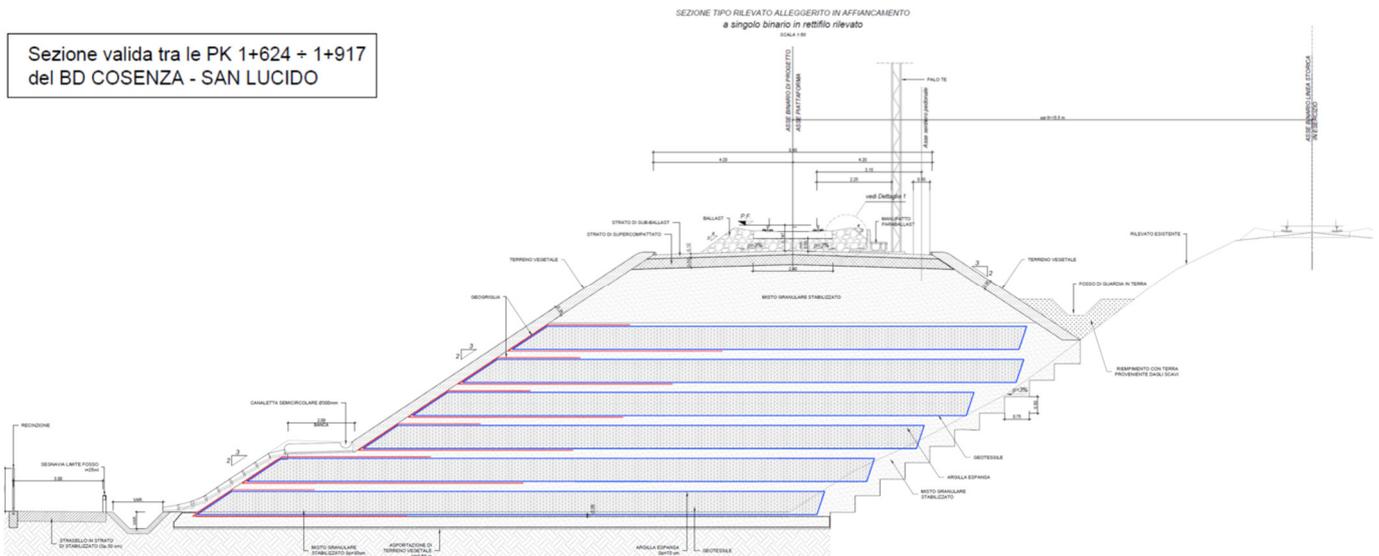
Sezione tipo in rilevato alleggerito a singolo binario in affiancamento
